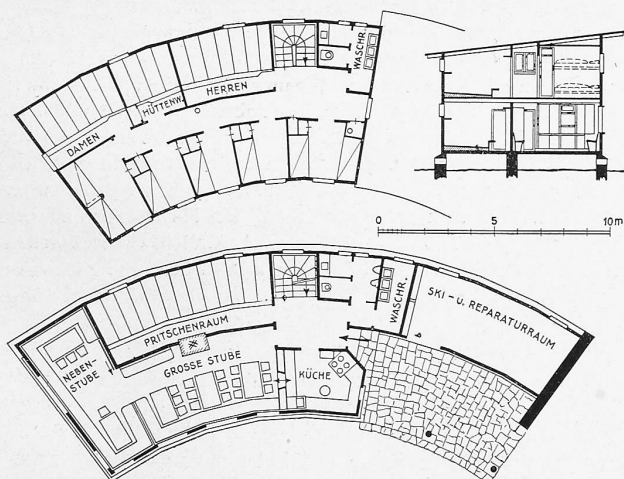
Ortstockhaus, Grundrisse und Schnitt. — 1 : 300.
